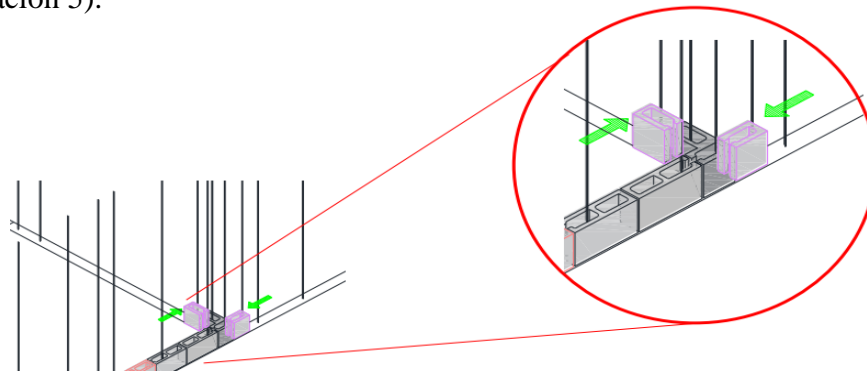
Muro corte, pieza mitad open end "C". Fuente del autor
